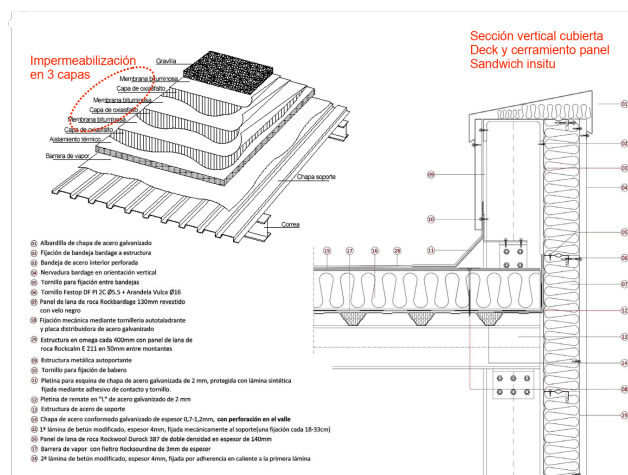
Cubierta Tipo Deck con Cerramiento Panel Sandwich "in situ".
